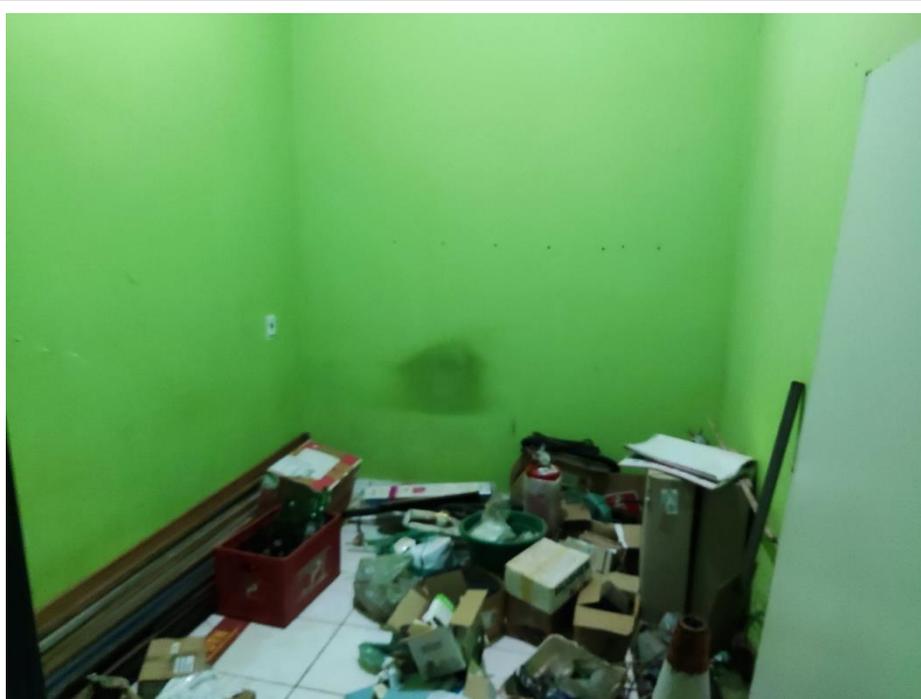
Prédio para locação em Paranatinga – Sala arquivo. Foto em 14/03/2024.
